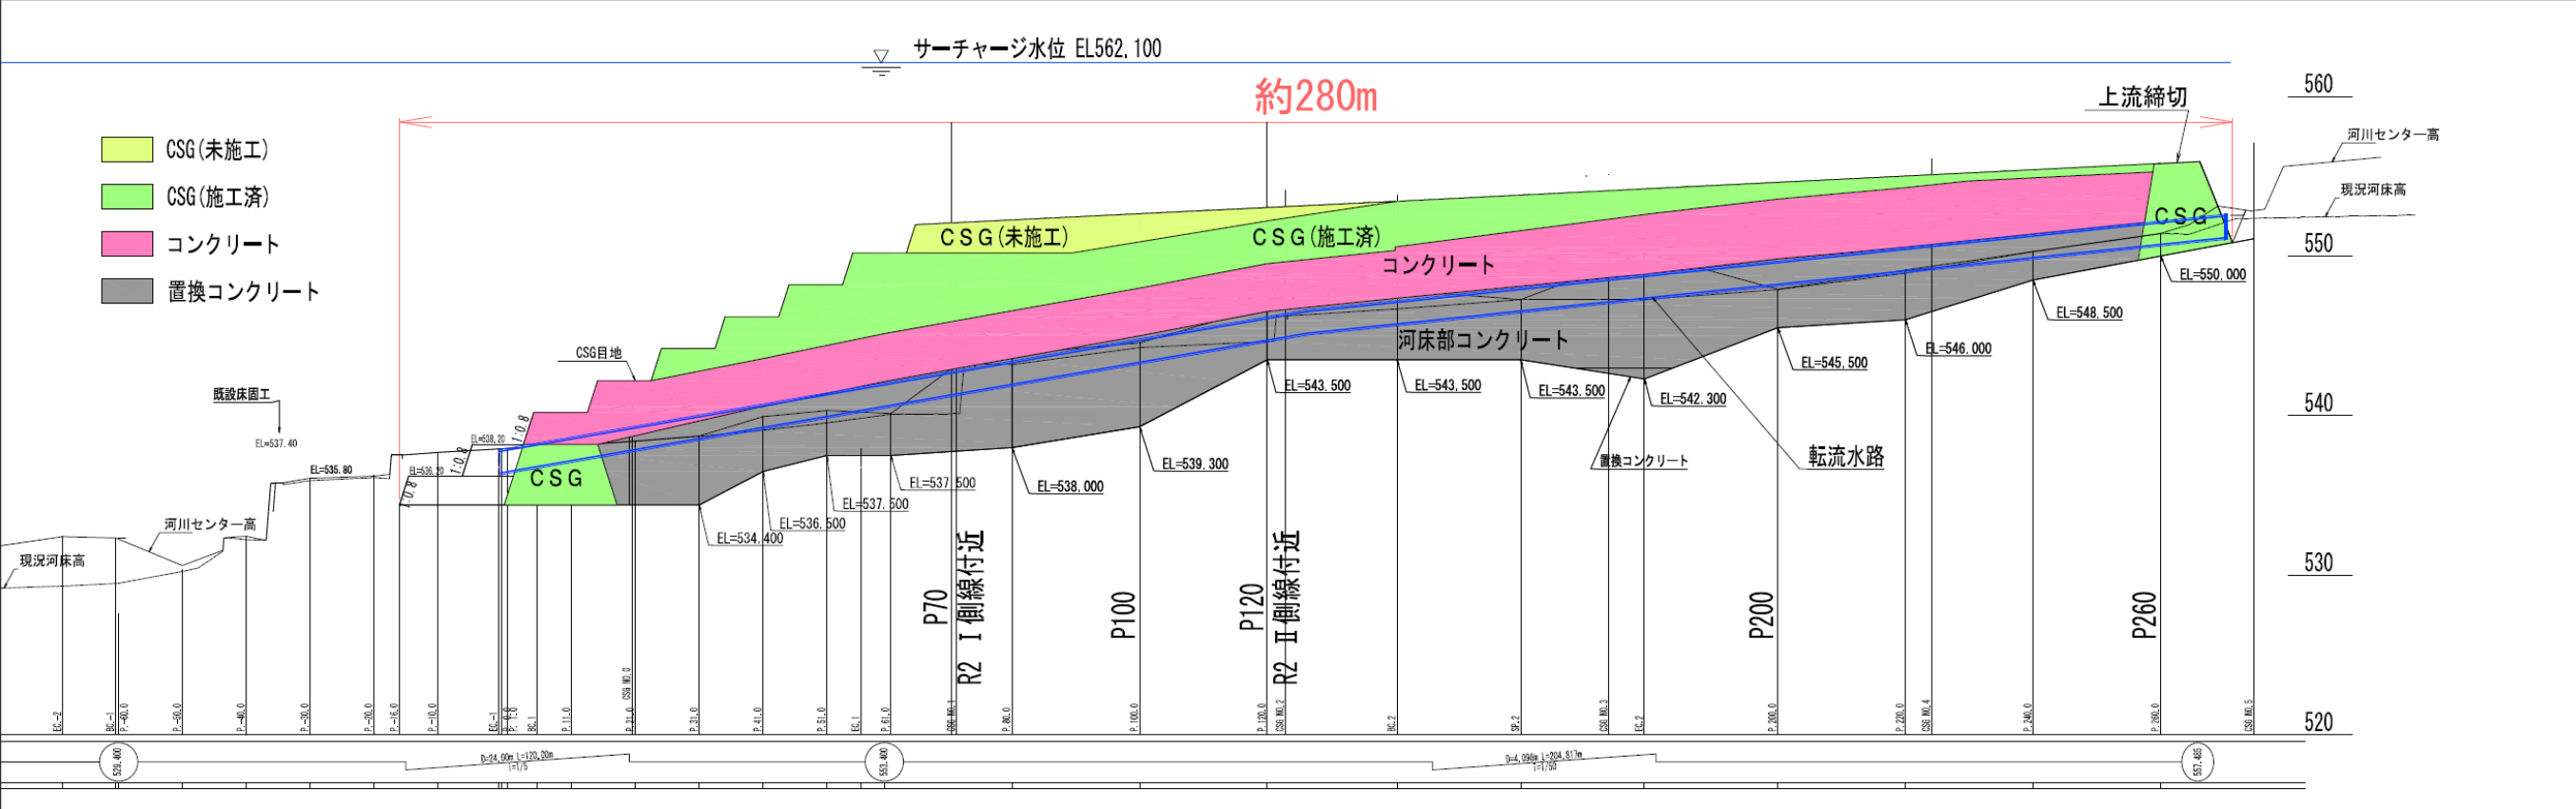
河床部コンクリートおよび CSG 施工実績図
